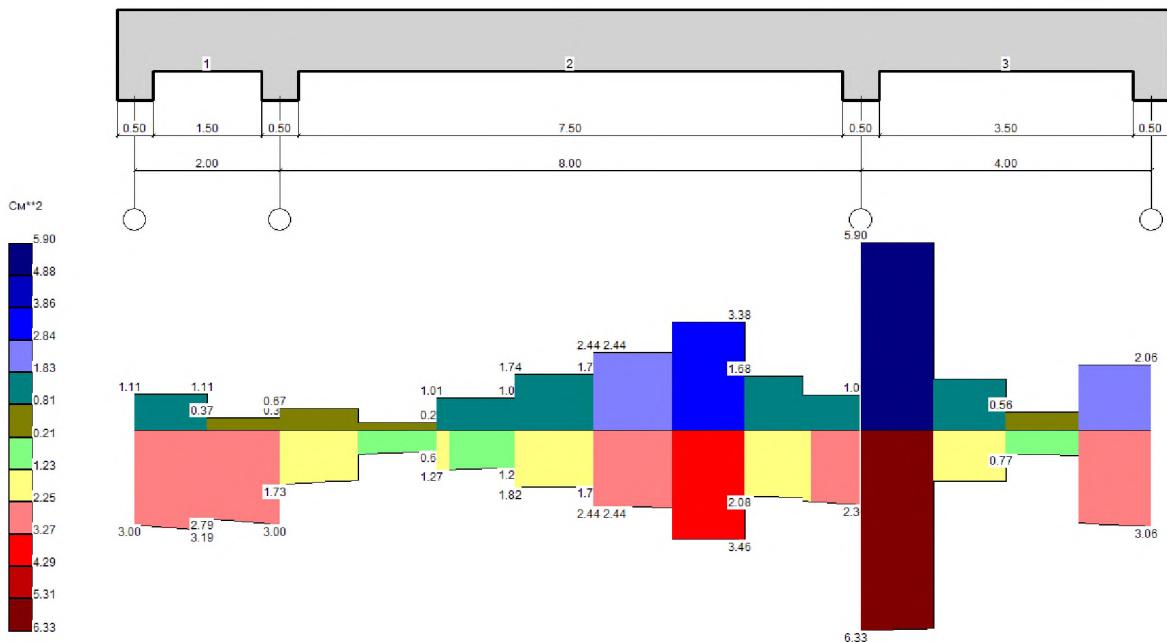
Балка № 5. Епюра поперечного армування
